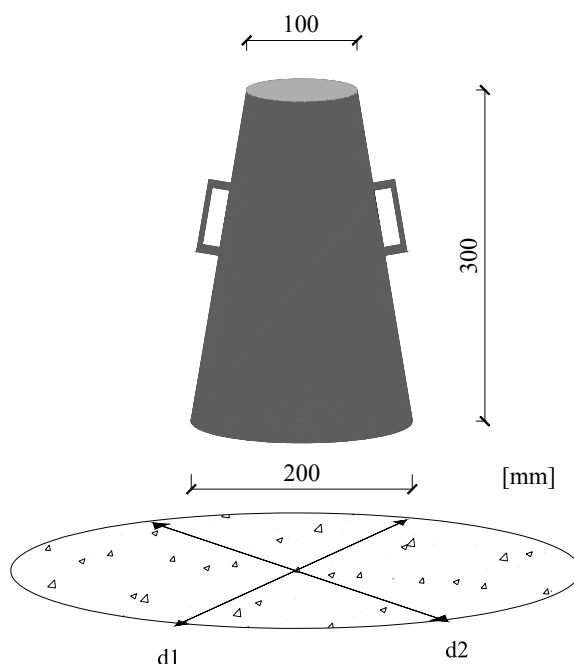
Equipamento para o ensaio de espalhamento do betão.
